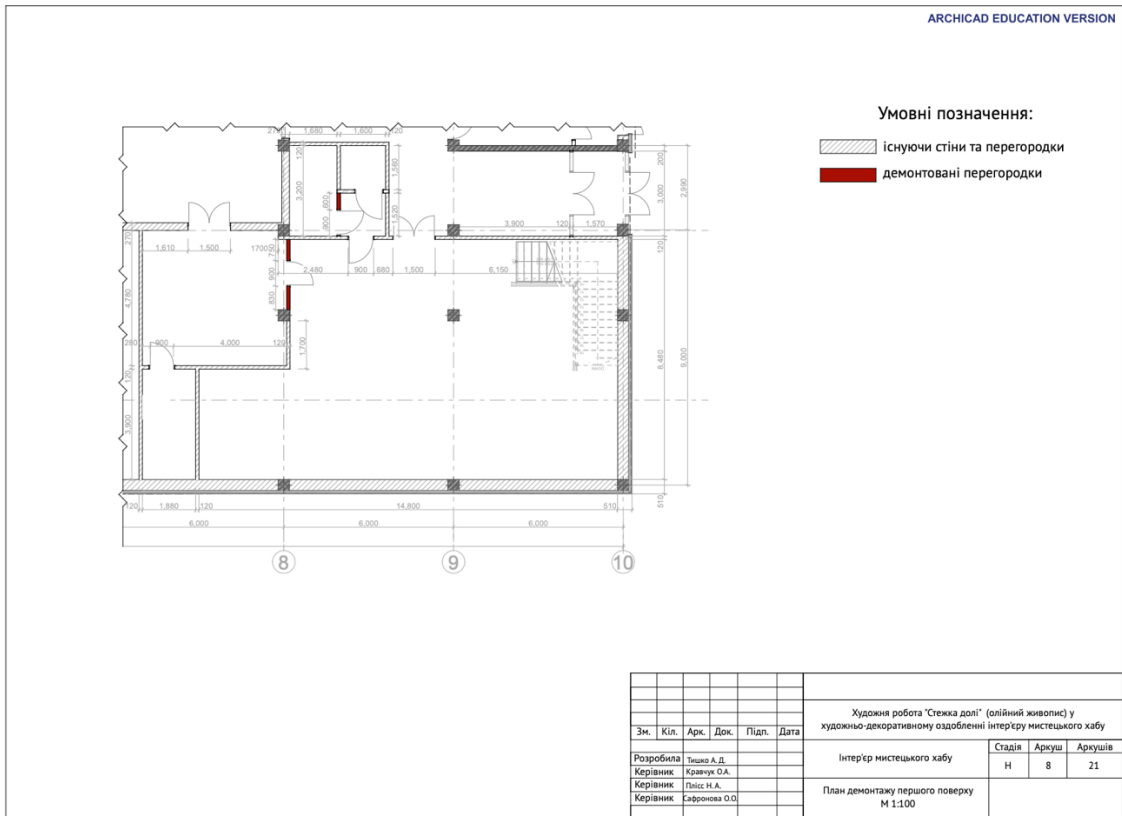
План демонтажу першого поверху хабу (М 1:100)
